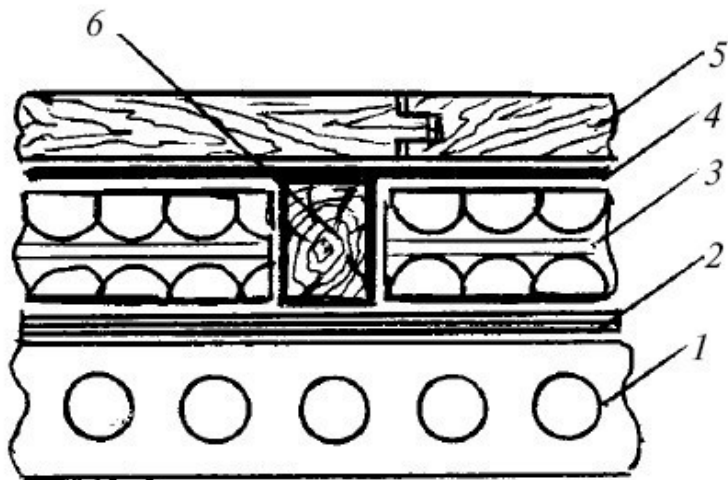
Теплоизоляция в случае наличия перекрытия, разделяющего помещения с разными температурными режимами: 1 – плита перекрытия; 2 – гидроизоляция; 3 – теплоизоляция; 4 – пароизоляция; 5 – настил пола; 6 – лага
